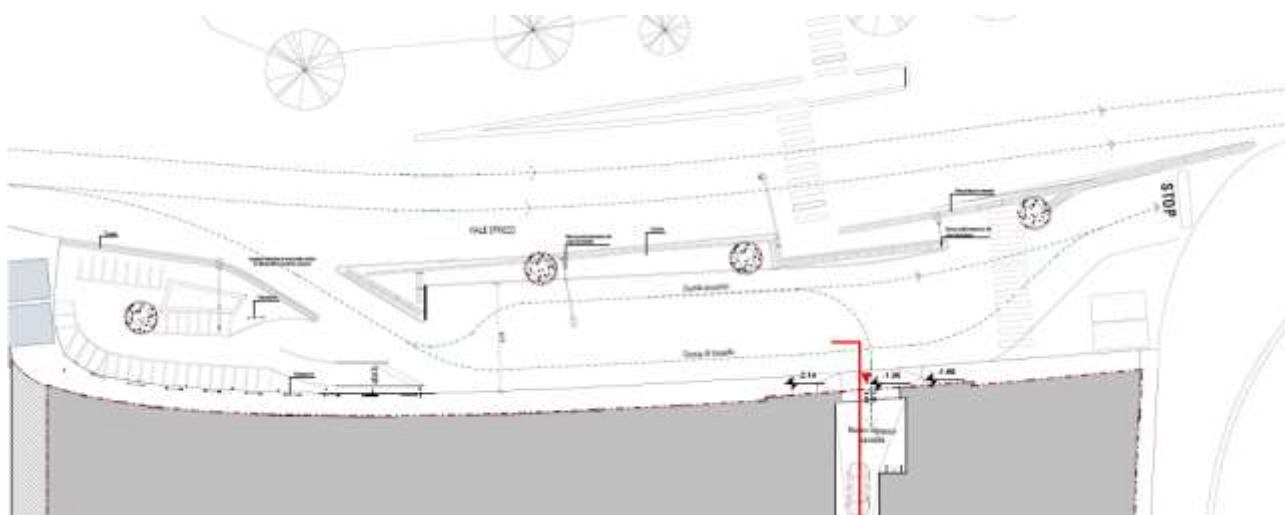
schema planimetrico dell'area a parcheggio su viale Strozzi
